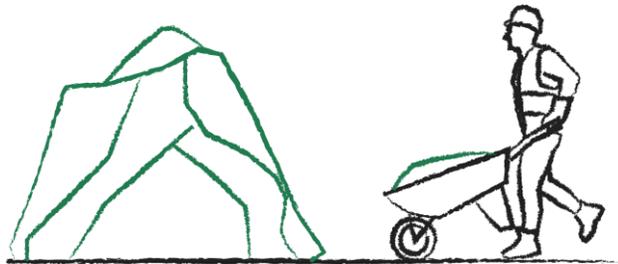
Acarreo de material producto de excavación. Fuente: Elaboración propia.
